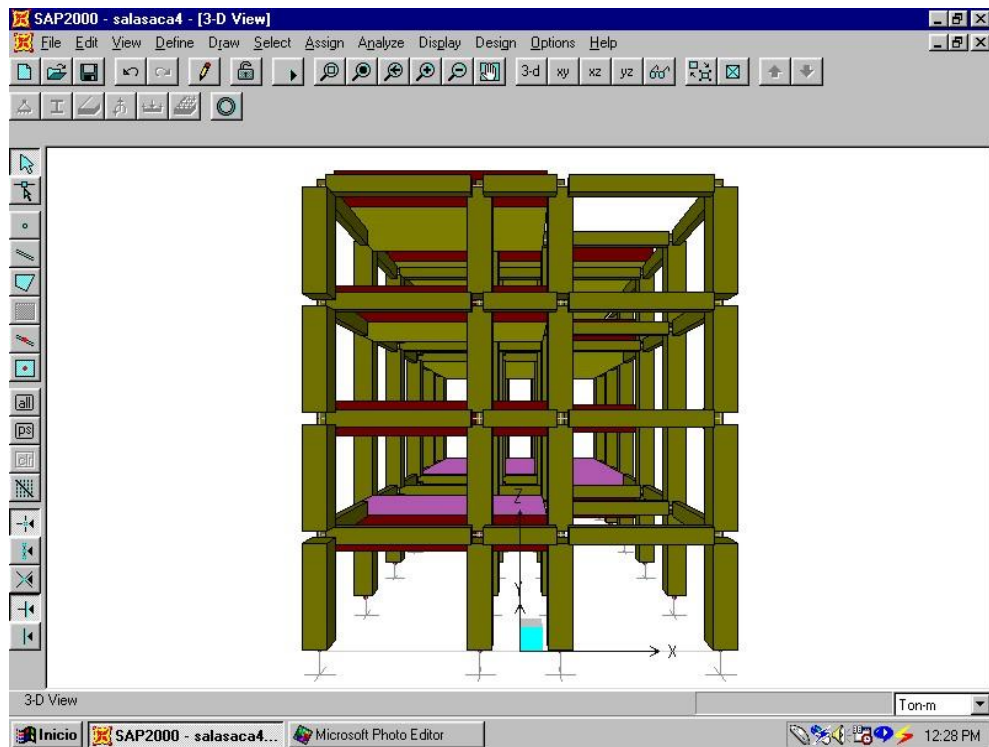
Pórtico espacial. Secciones de vigas, columnas y losas en el plano Y-Z.
